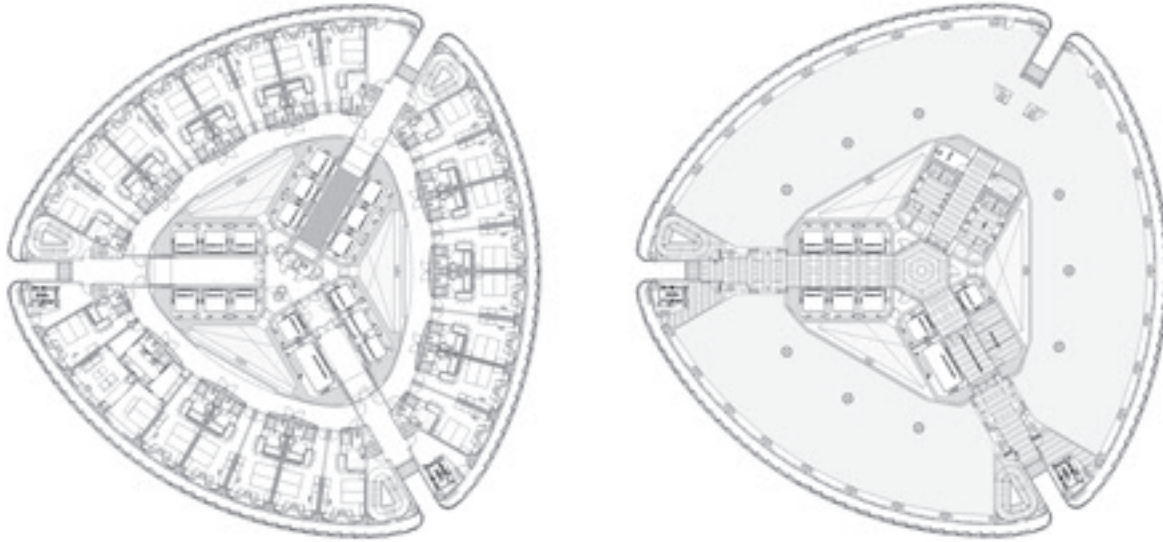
Plantas tipo de hotel (izqda.) y oficinas (dcha.).
